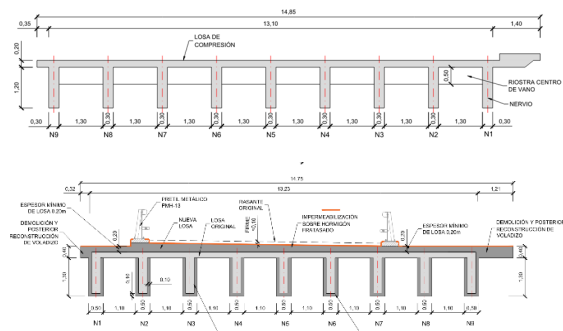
Sección transversal existente y sección transversal tras las obras de reparación
